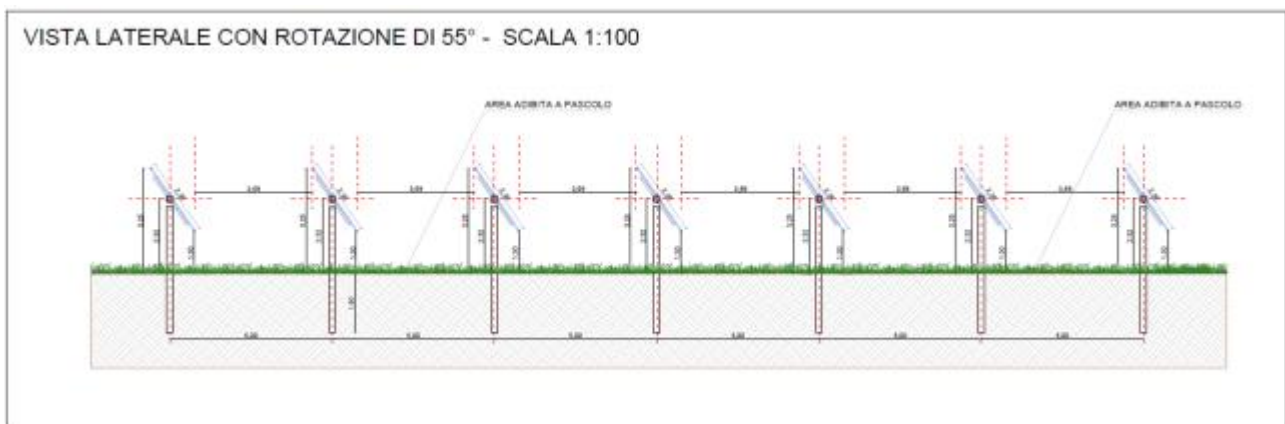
Vista laterale delle strutture con rotazione di 55°.
